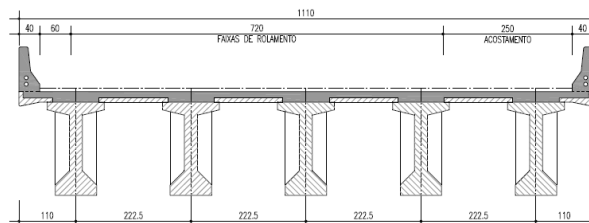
Obra de duplicação. Seção transversal típica.
